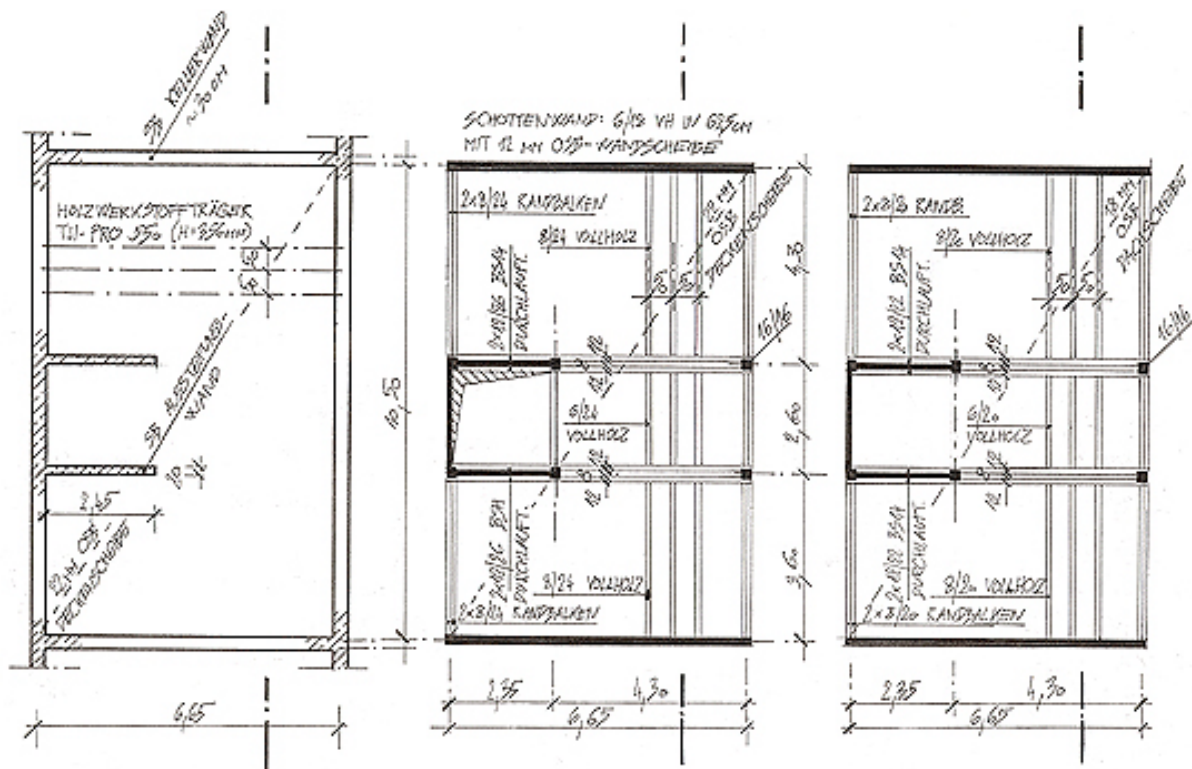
Grundrisse vom Tragwerk Reihenhaus-breit Kellerdecke, Zwischendecke und Dach
